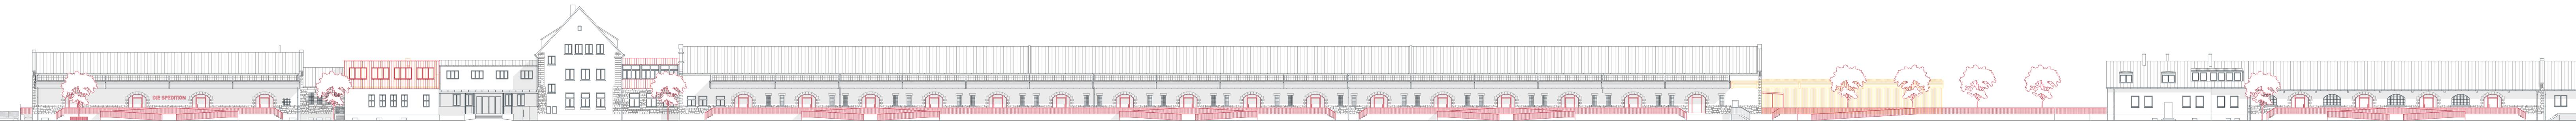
Gesamtanlage: Bauliche Veränderungen, Süd-West-Fassade M1:250
